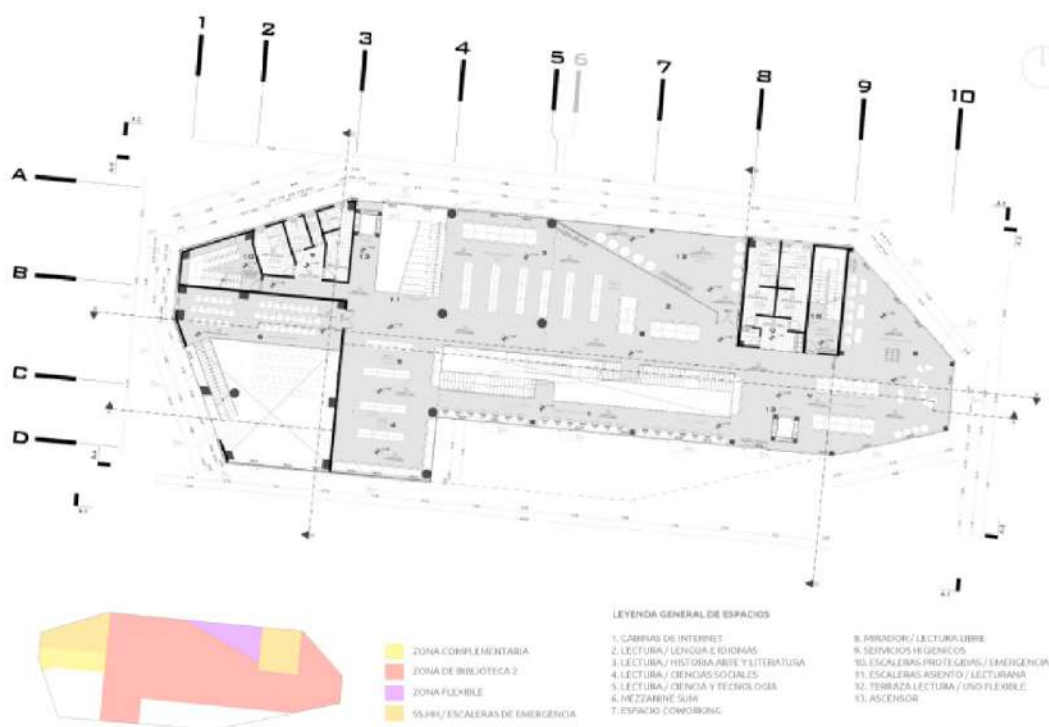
Plano de Tercera Planta del bloque de biblioteca
